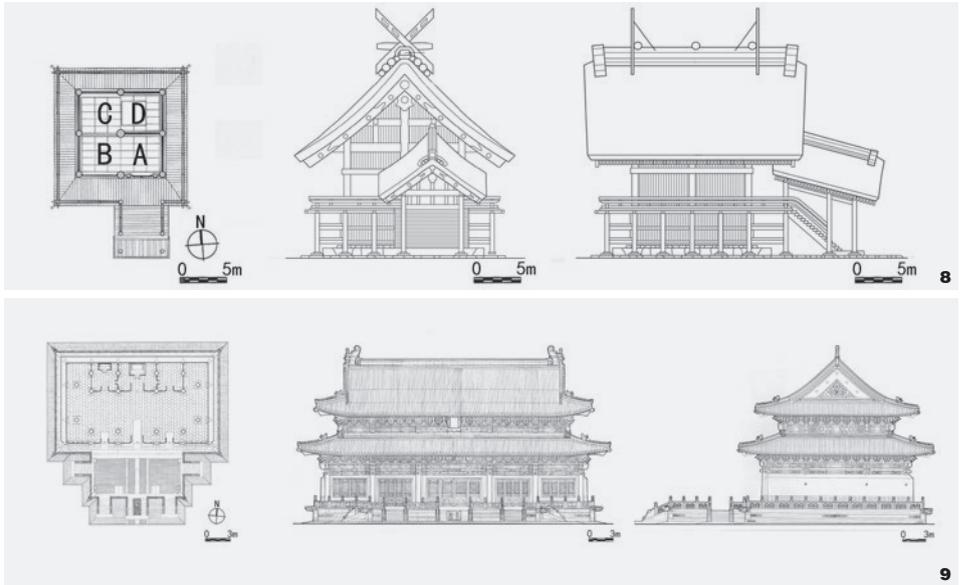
中国陵寝建筑隆恩殿平面图、立面图、侧立面图
